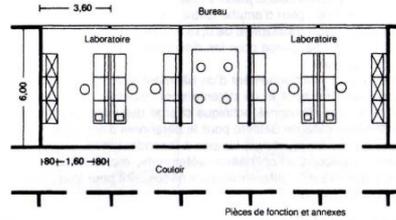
Plan d'un laboratoire de recherche. (Ernst Neufert 10^e édition française, Les éléments des projets de construction, pp 248)
